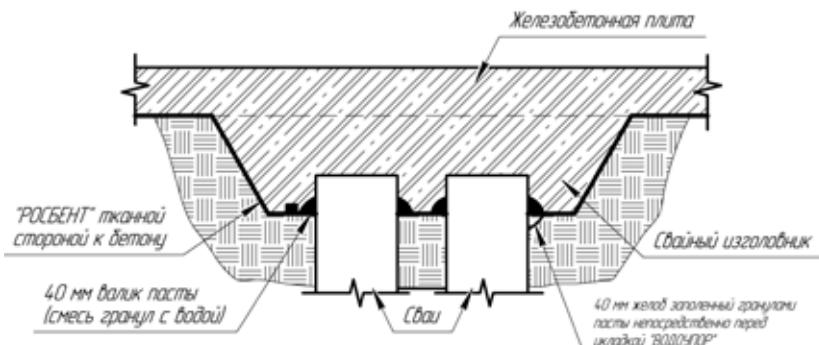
Гидроизоляция подплиточных свай и свайного наголовника.
